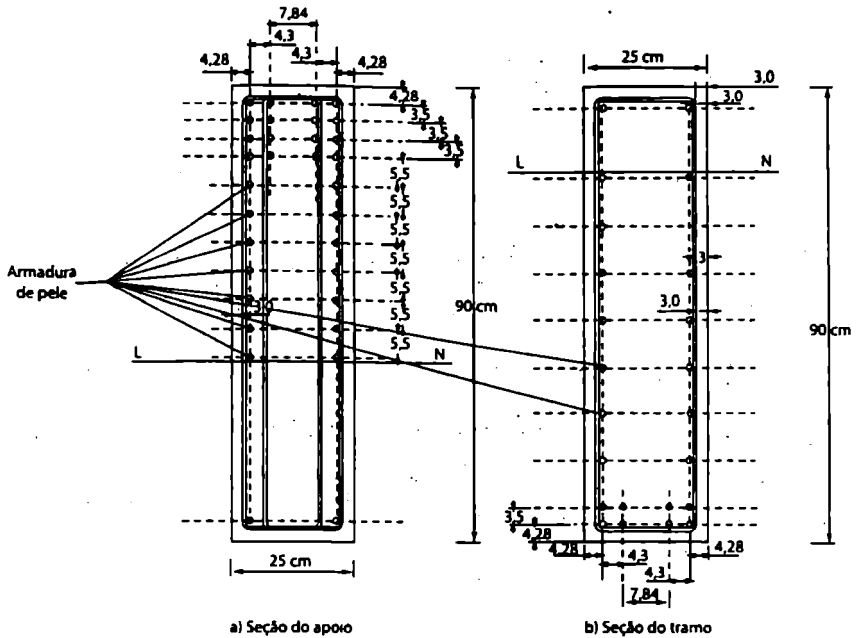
Detalhamento das seções transversais mais solicitadas da V101.
